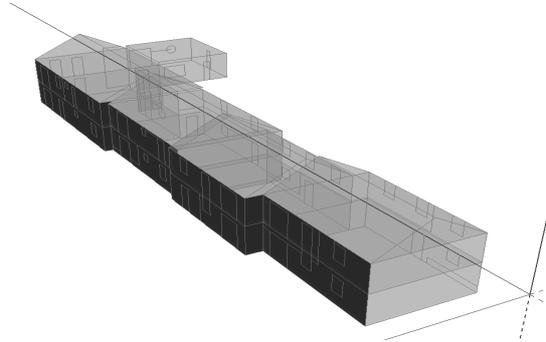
Sélection d'une façade complexe à l'aide d'une requête par plan de coupe : « PLAN(plan sélectionné, direction1) » où plan sélectionné est le plan de la face la plus renfoncée de la façade et direction1 = une des deux direction pour le plan (obtenue en testant les deux possibilités)
